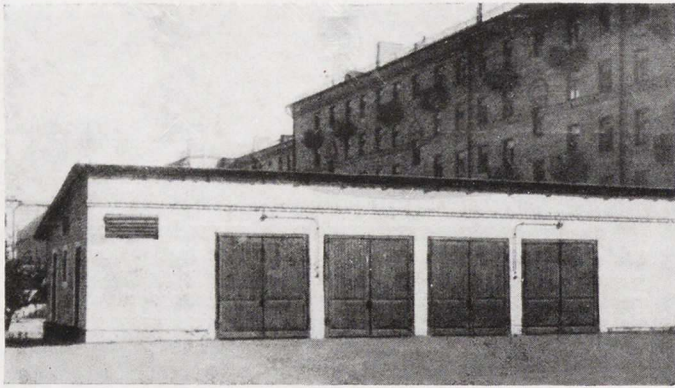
Запорожье. Квартал 83. Типовые гаражи и мусоросборники
